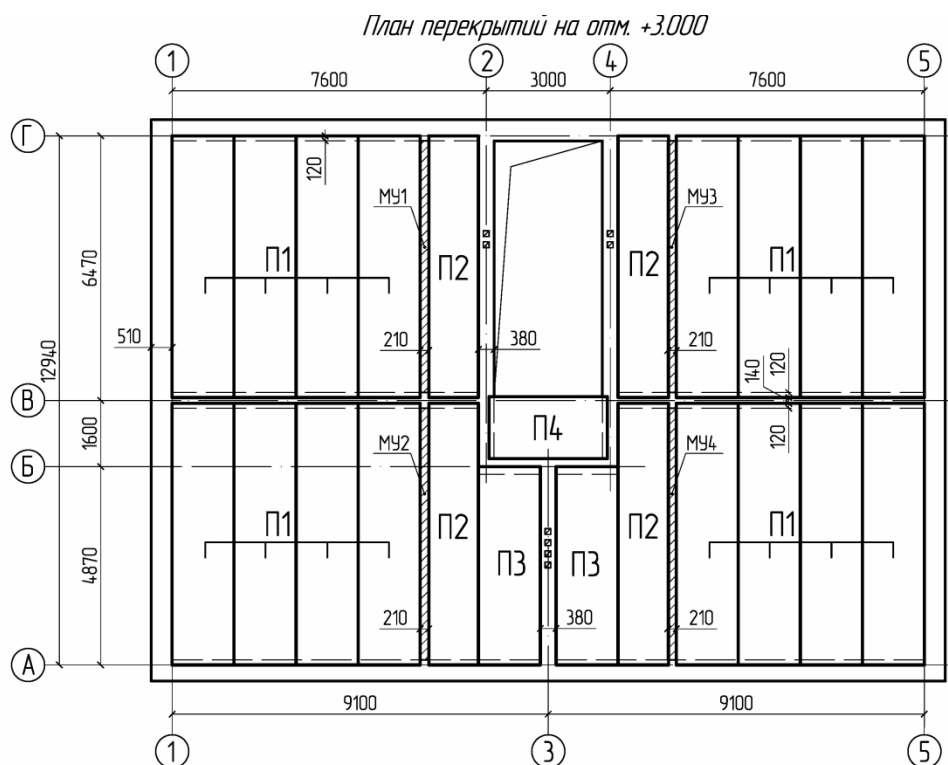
Пример вычерчивания плана плит перекрытия
